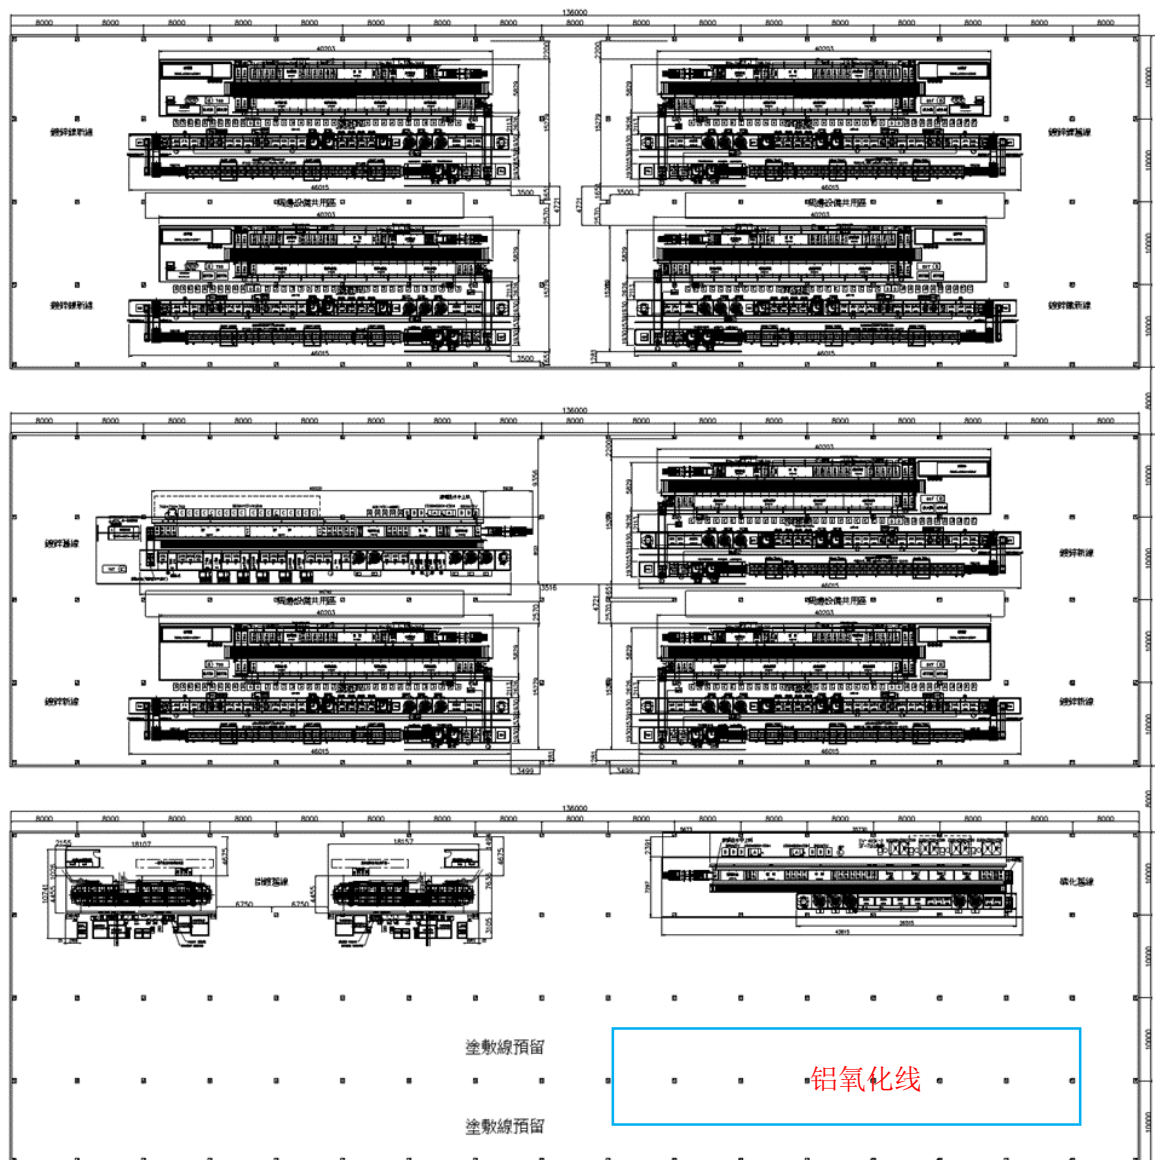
1#厂房 2F 表面处理车间平面布置示意图
